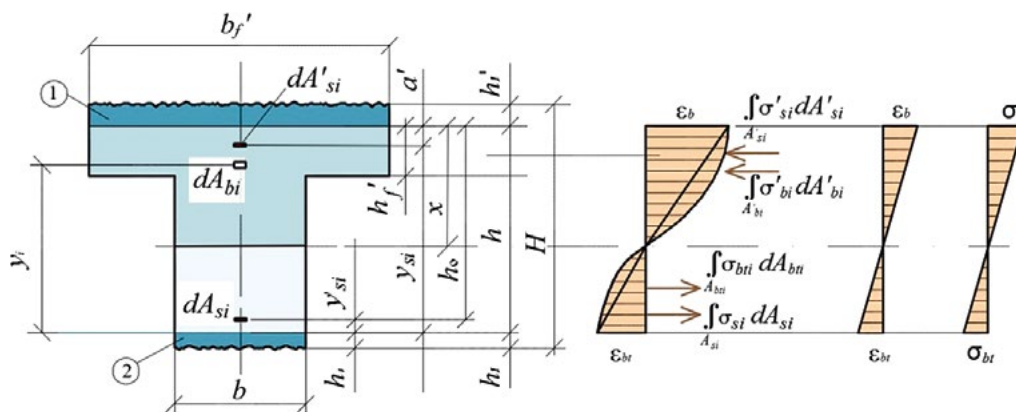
Расчетная схема сечения. h_1 и h_1' – соответственно высота поврежденного бетона в растянутой и сжатой зонах
